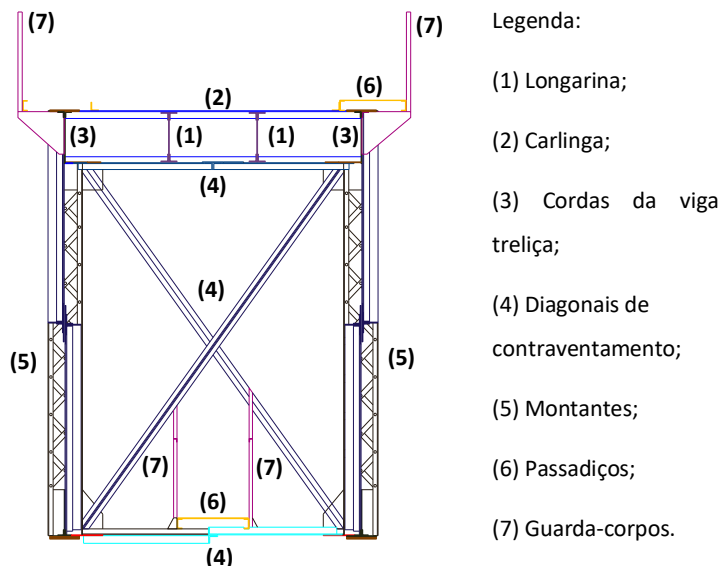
Corte transversal e vista interior da ponte ferroviária da Baía.
